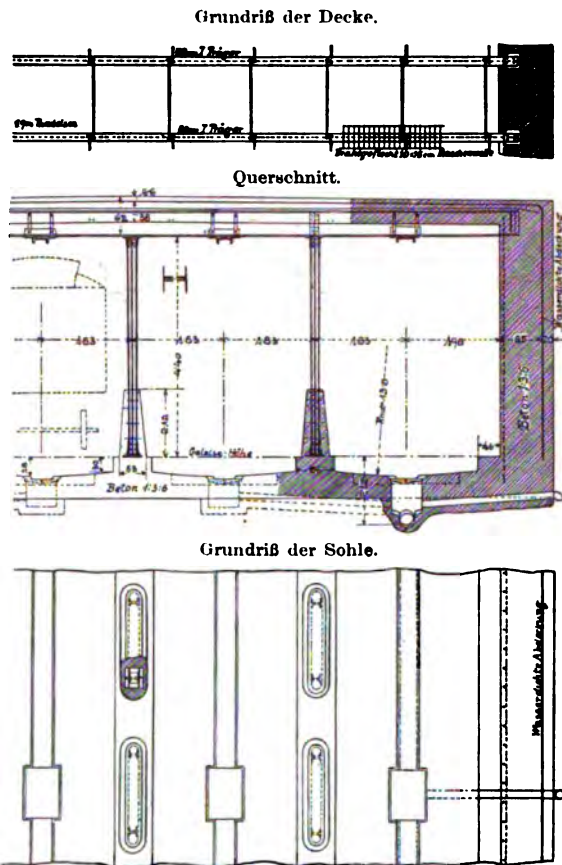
Querschnitt und Grundrisse der Untergrundbahn in Philadelphia.
